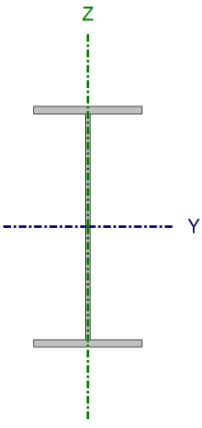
Viga más desfavorable. Fuente: CYPE 3D.
